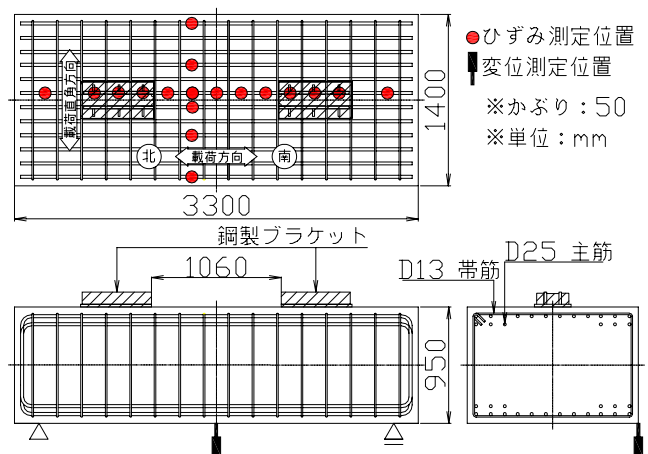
供試体配筋状況と主鉄筋ひずみ測定位置
